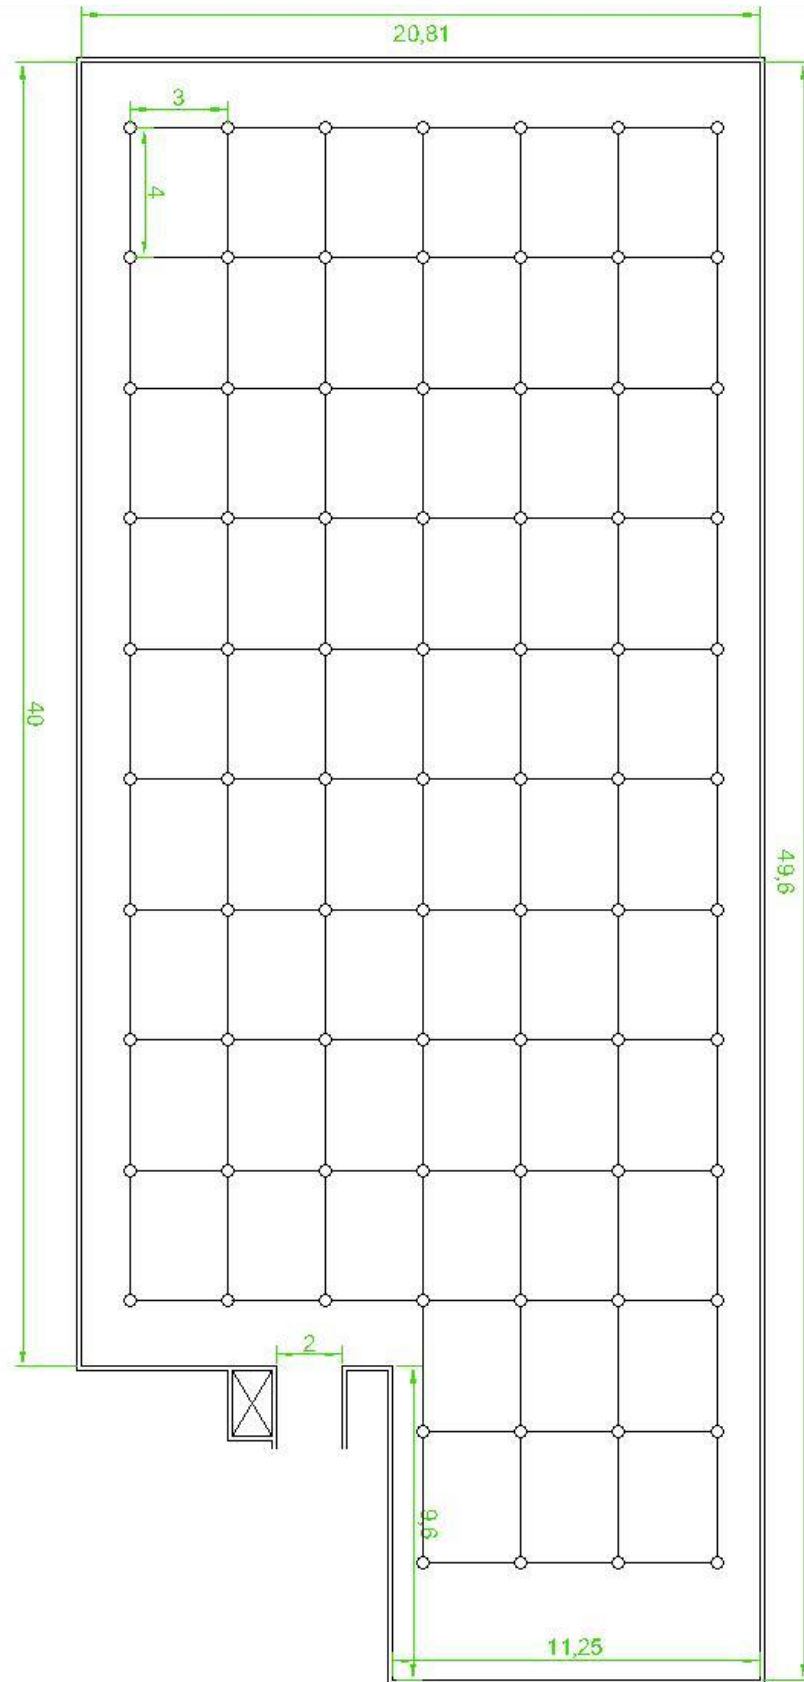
Arranjo do sistema de *sprinklers* do pavimento 3
